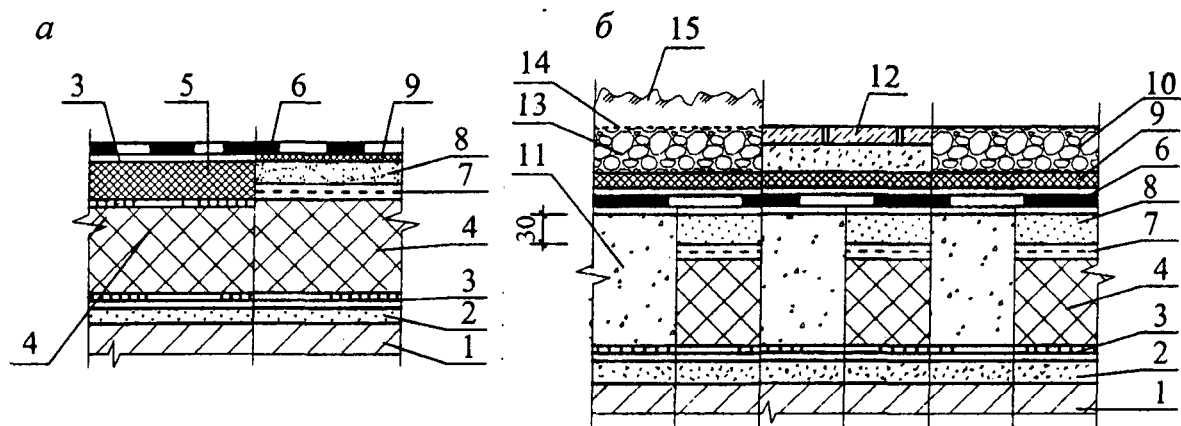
Устройство мембранной кровли в традиционном варианте:
